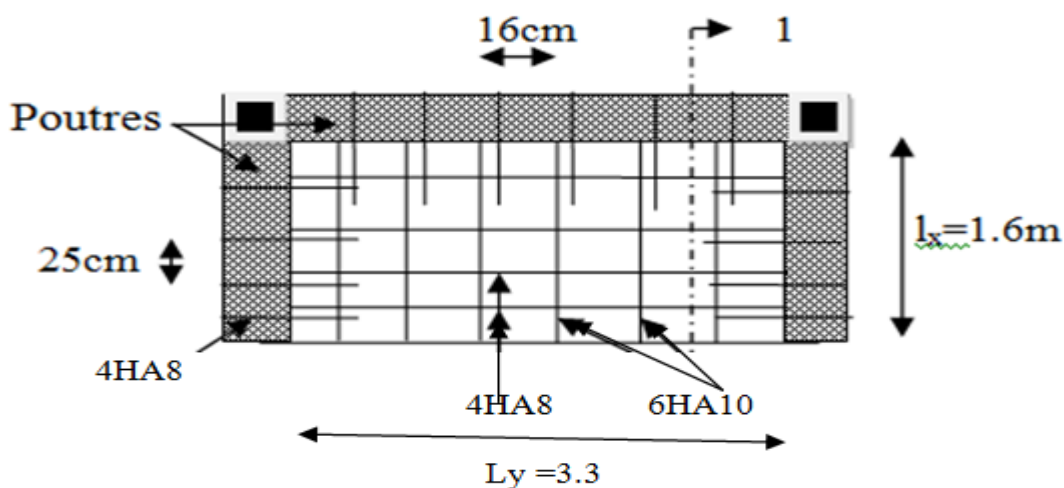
schéma de ferrailage de la dalle sur 3 appuis.
